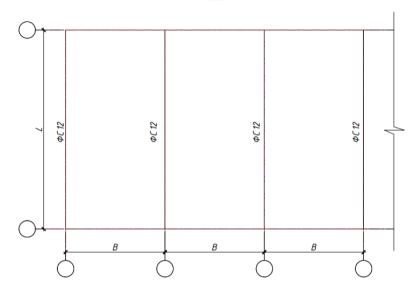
Вариант 1 — покрытие без подстропильных ферм
